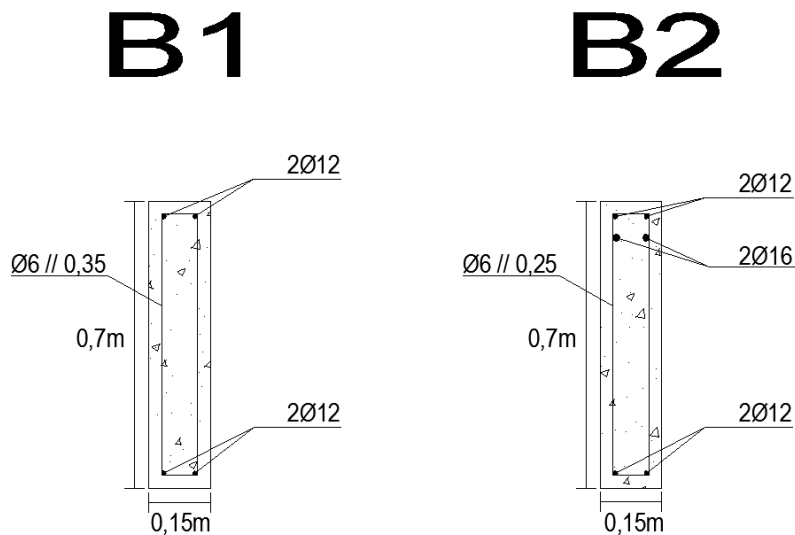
Corte transversal da viga de piso 1 do pórtico 1-1'
